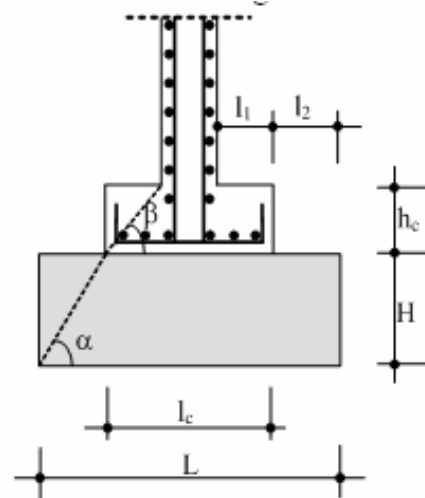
Fundație tip bloc și cuzinet sub pereți de beton armat
